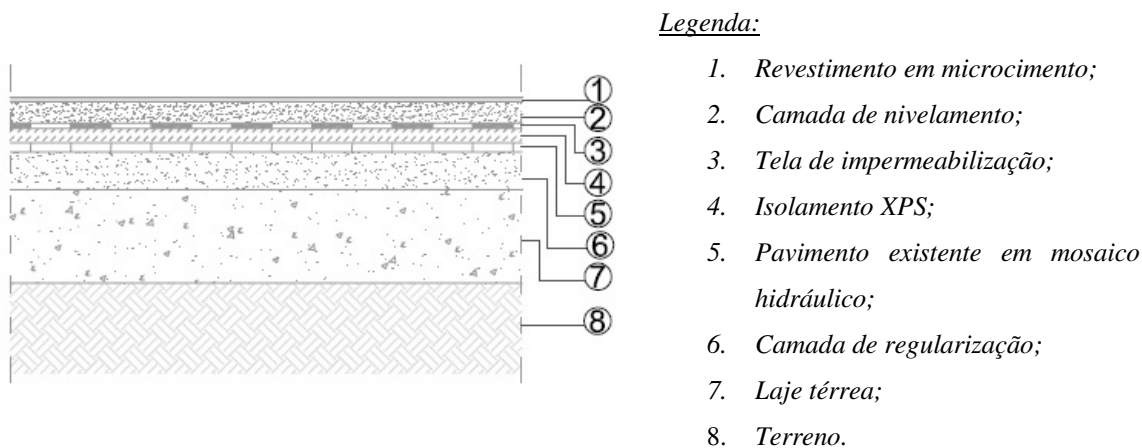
Pormenor construtivo do pavimento da fração comercial.
